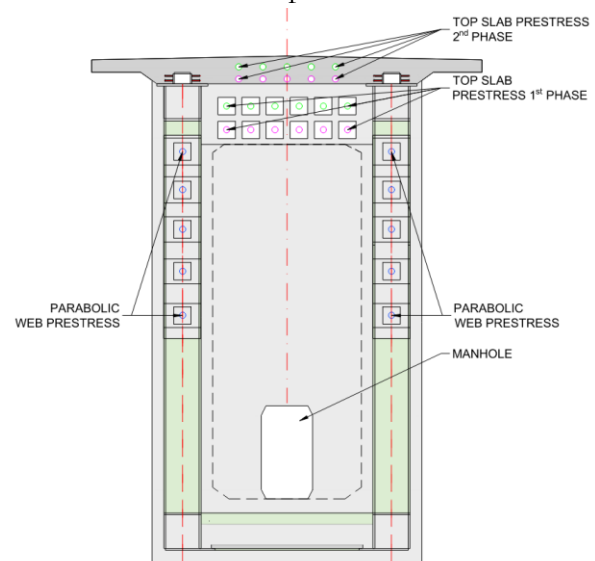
Conexión de la celosía al vano de hormigón mediante pretensado.
